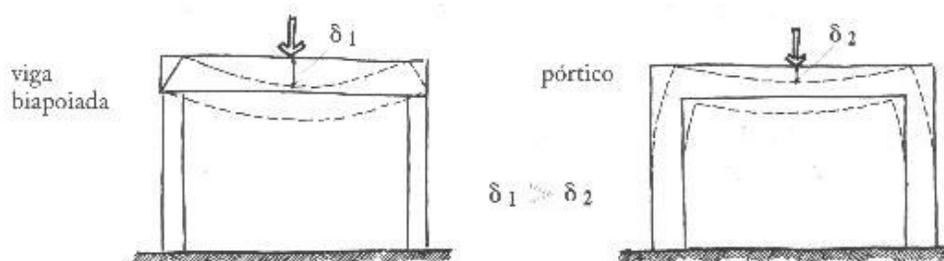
Deformações em vigas biapoiadas e pórticos.
